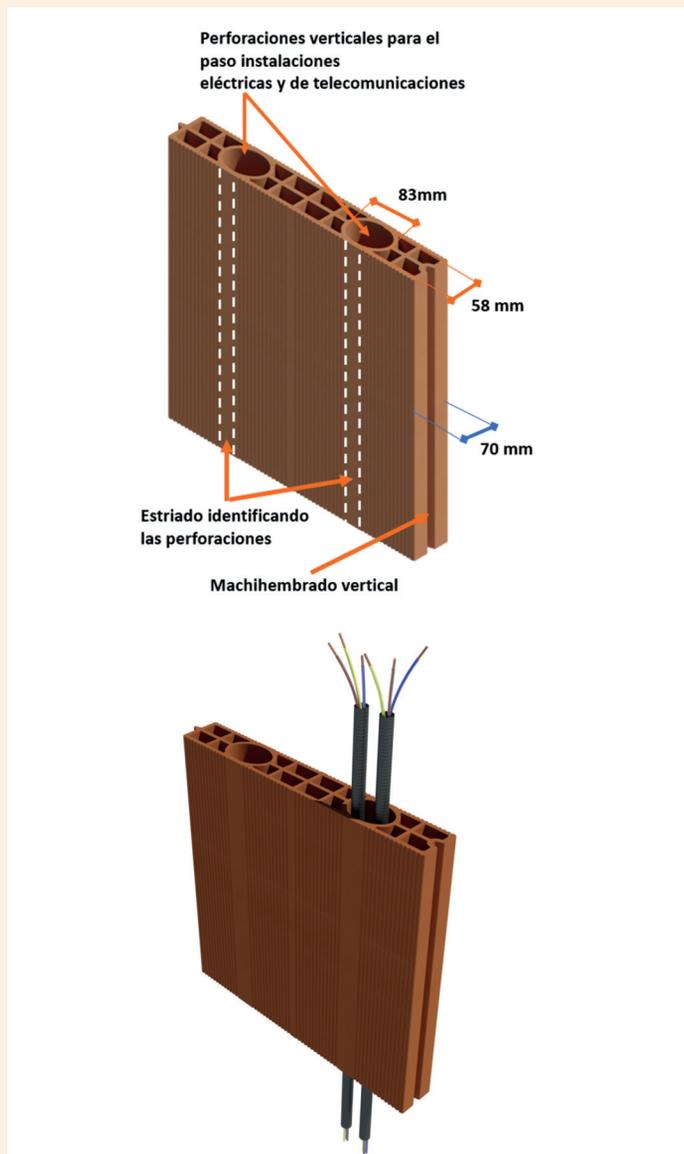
Pieza de ladrillo hueco gran formato MURALIT Sin Rozas
